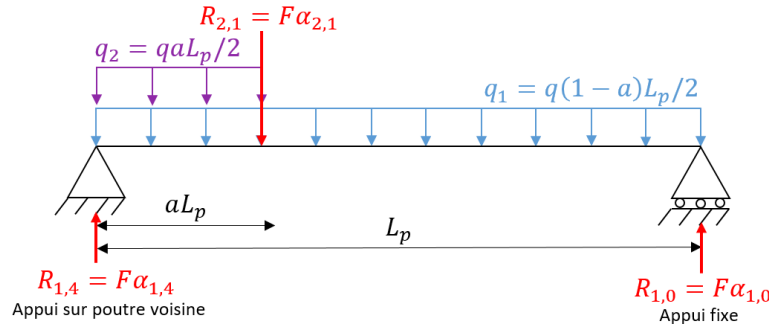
Schéma statique d'une poutre type 1 soumise à un chargement uniformément distribué
